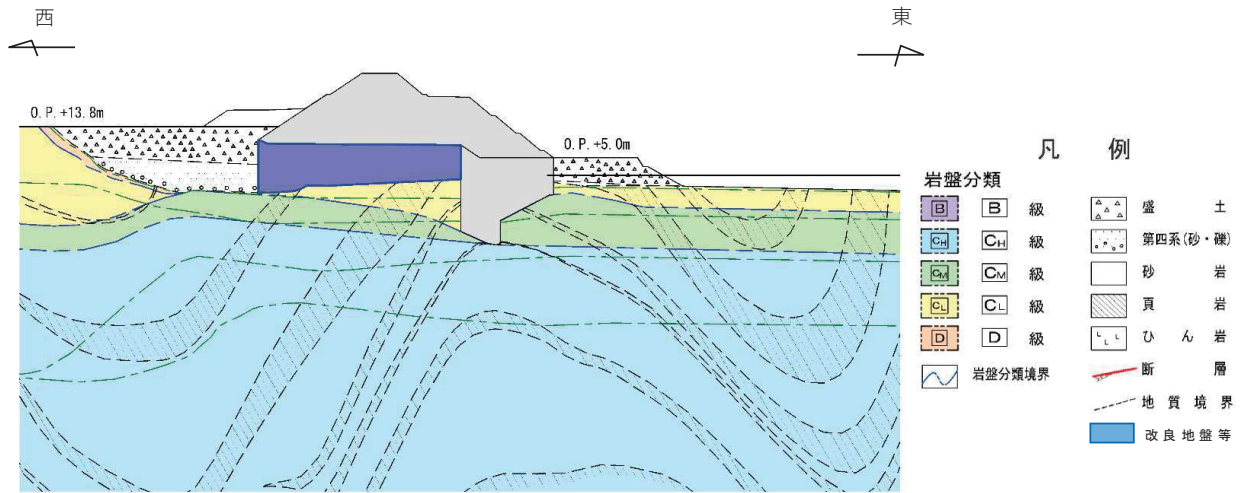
10. 3-11 盛土堤防 I-①断面 (断面⑧)
